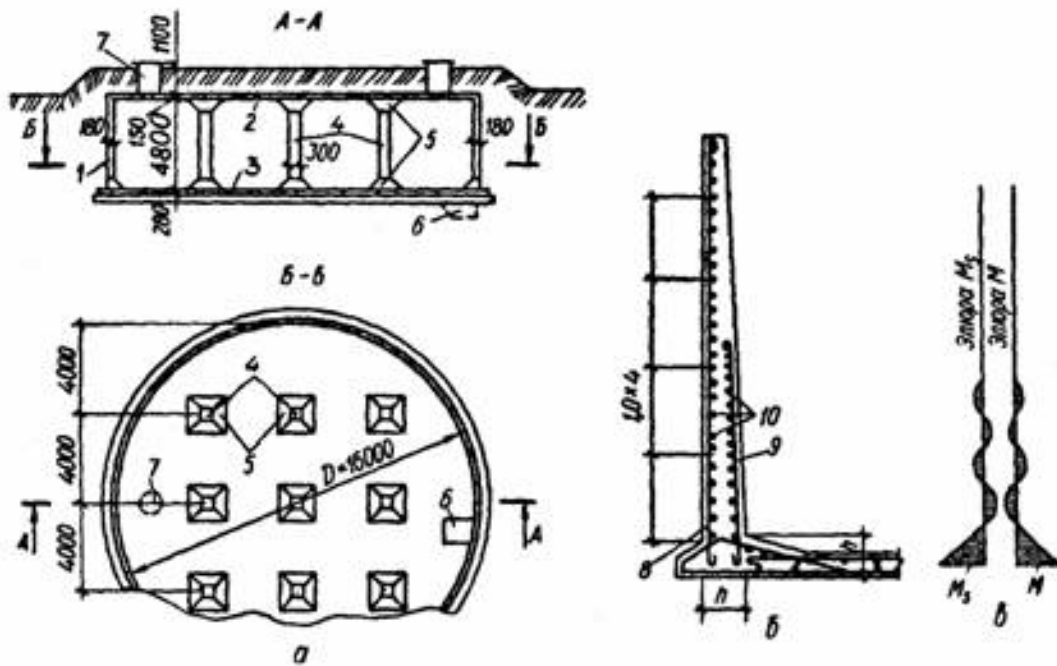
Циліндричний залізобетонний монолітний резервуар з балковим покриттям: а – конструкція резервуара; б – армування стінки; в – еюра згинальних моменті у стінці від тиску ґрунту і рідини; 1 – стінка; 2 – безбалкова плита перекриття; 3 – плита днища; 4 – колони; 5 – капітелі; 6 – прямики; 7 – люк; 8 – вертикальна арматура за розрахунком на момент від тиску ґрунту; 9 – те саме на момент від тиску рідини; 10 – кільцева арматура за розрахунком на розтягувальні зусилля
